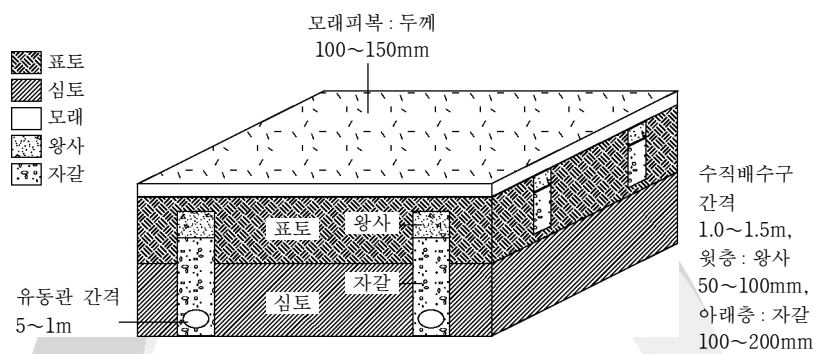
모래카펫지반(sand carpet drainage system)
